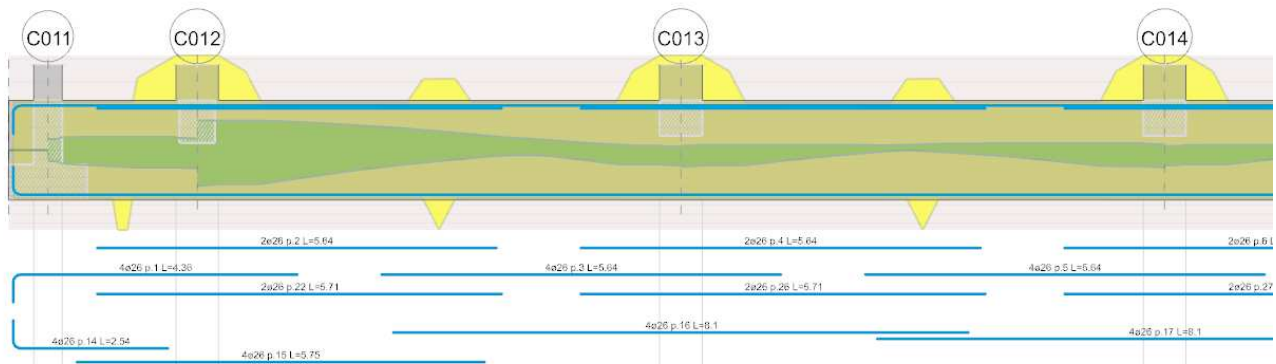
Schema indicativo disposizione armature travi di fondazione a T rovescia
